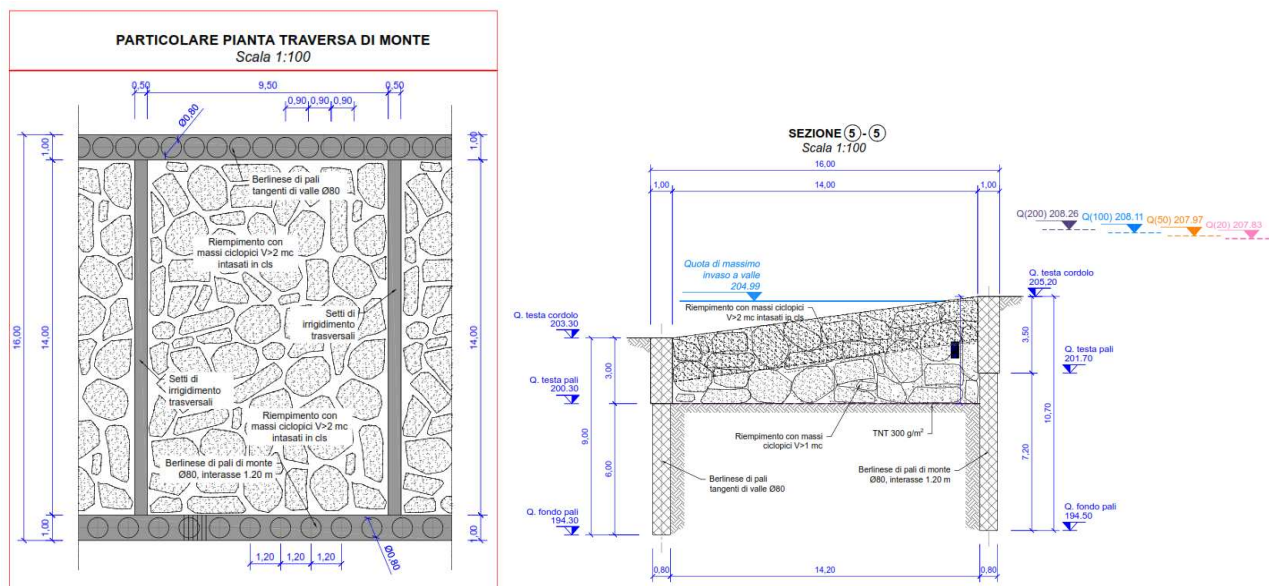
particolari estratti dalle tavole di progetto 3.2.1 – 3.2.3
